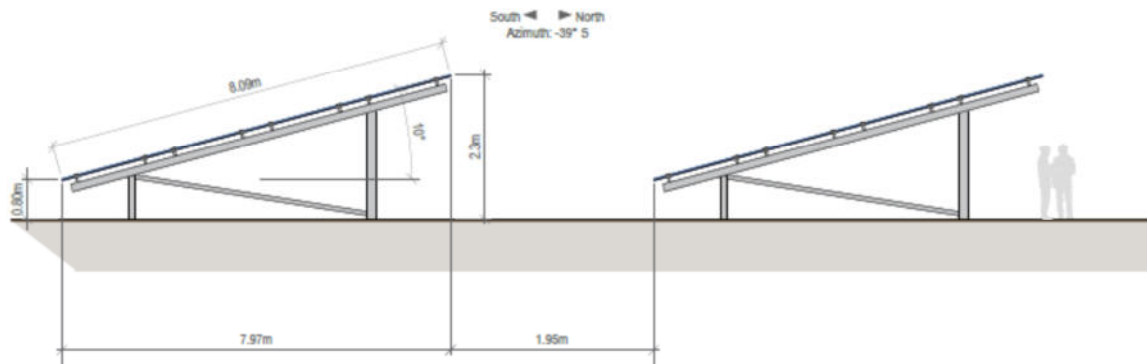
Schnittzeichnung Gestell - Seitenansicht
